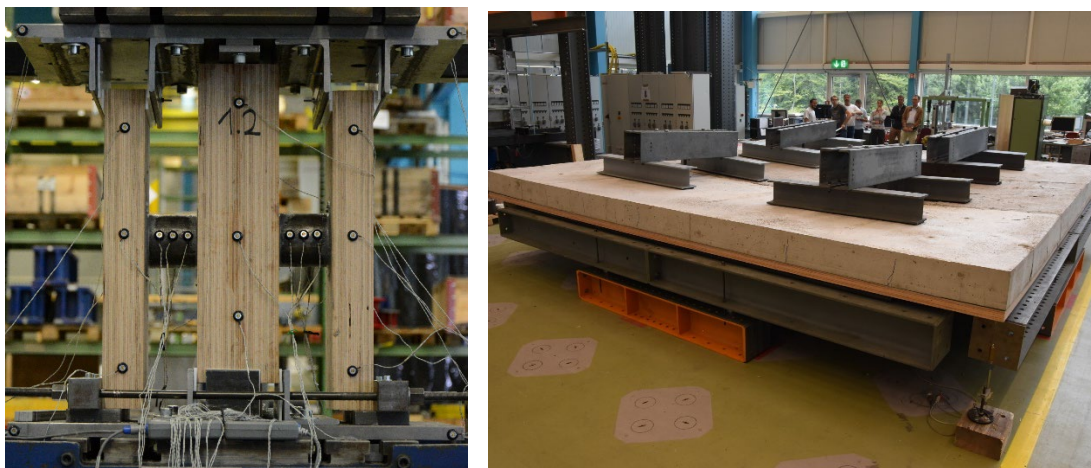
Holz-Beton-Verbunddecke mit Buchenplatten und Stahlrohren: Push-out Versuch (links) und Grossversuch an einem belasteten zweiachsigen tragenden Deckenelement (rechts)
